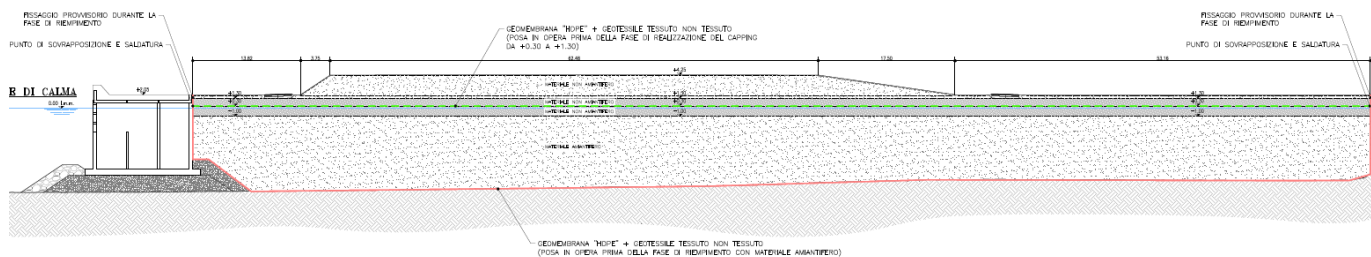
Sezione tipologica con individuazione della posa in opera della geomembrana HDPE + geotessile tessuto non tessuto
